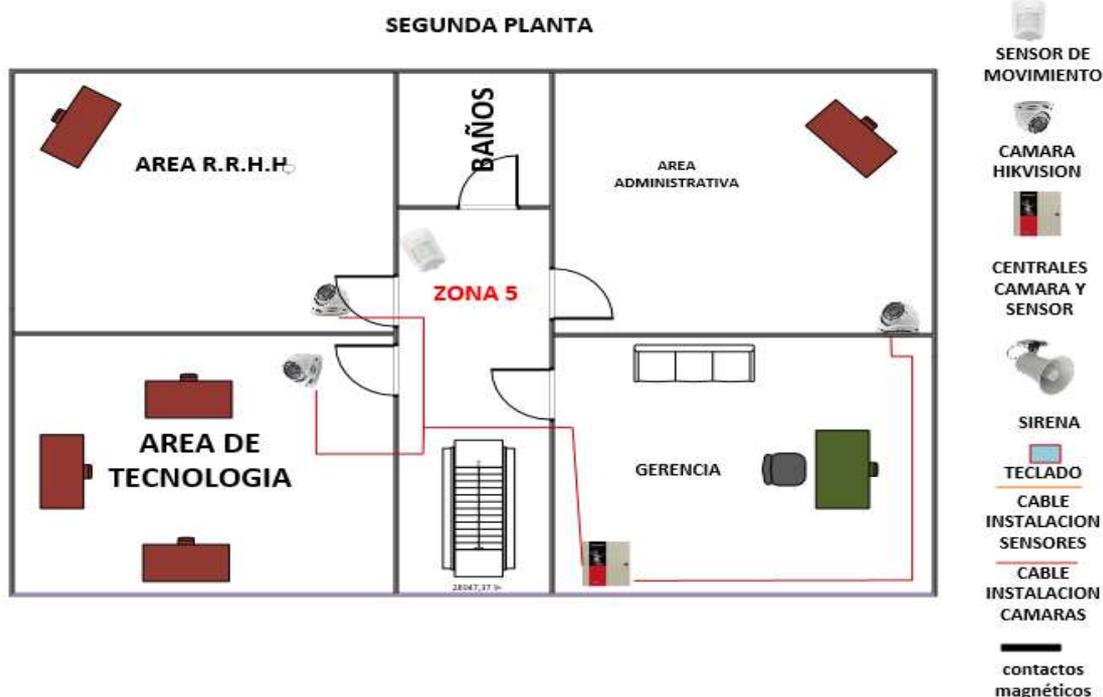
Ubicación estratégica de cámaras y sensores en segunda planta de Melproyect
